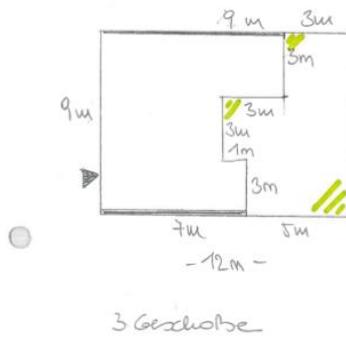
Grundrisse der Reihenhäuser mit Arbeitsbereich (im EG)(grau)
